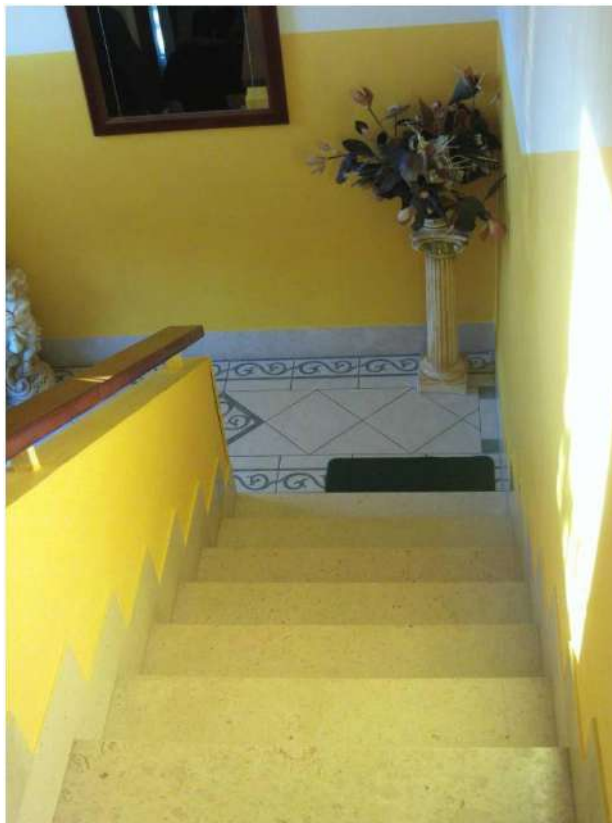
Foto interno : rampa di risalita verso sub 2 – piano 2°
